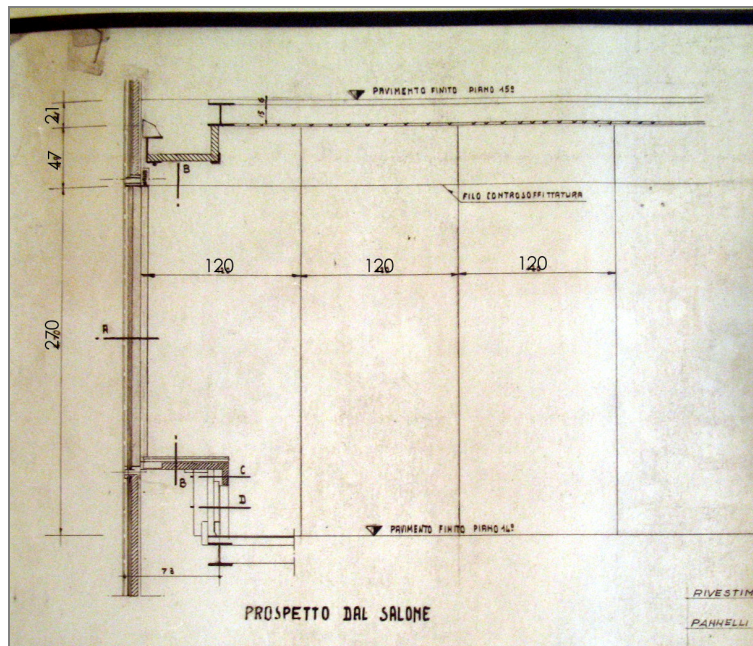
sezione pacchetto di facciata (fonte CSAC - stralcio tav. 60, archivio n. 234-1, rielaborazione f.m.)
